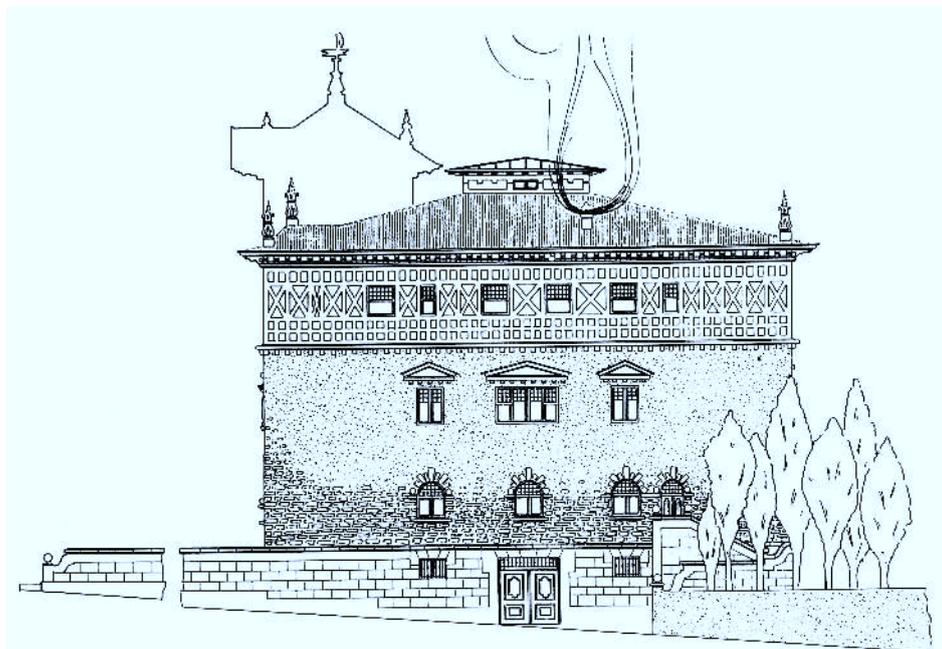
Proyecto para el Ayuntamiento de Carranza realizado en 1924 por el arquitecto Julio Sáenz de Barés. Alzado de la fachada zaguera. (Edificio no construido).
